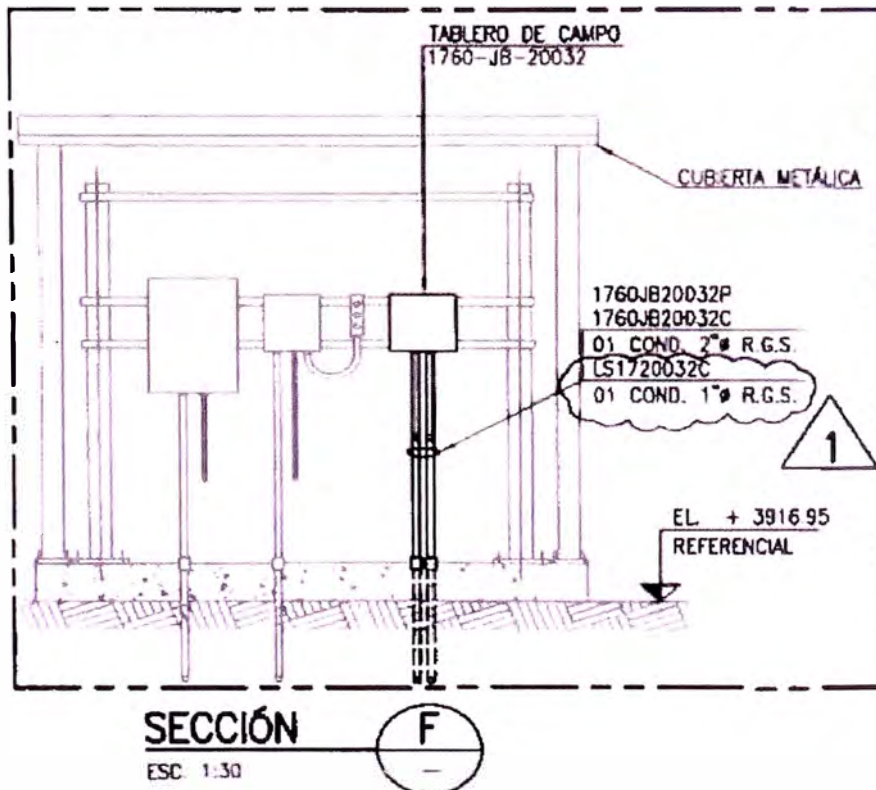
Detalle de acometida hacia la Junction Box 1760-JB-20032
